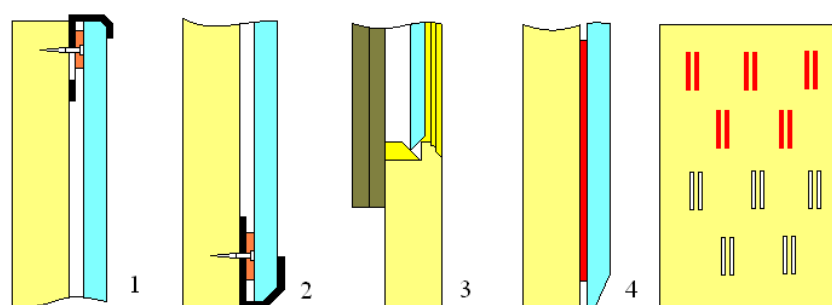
Установка зеркал: 1, 2 – держателями; 3 – бруском; 4 – скотчем
